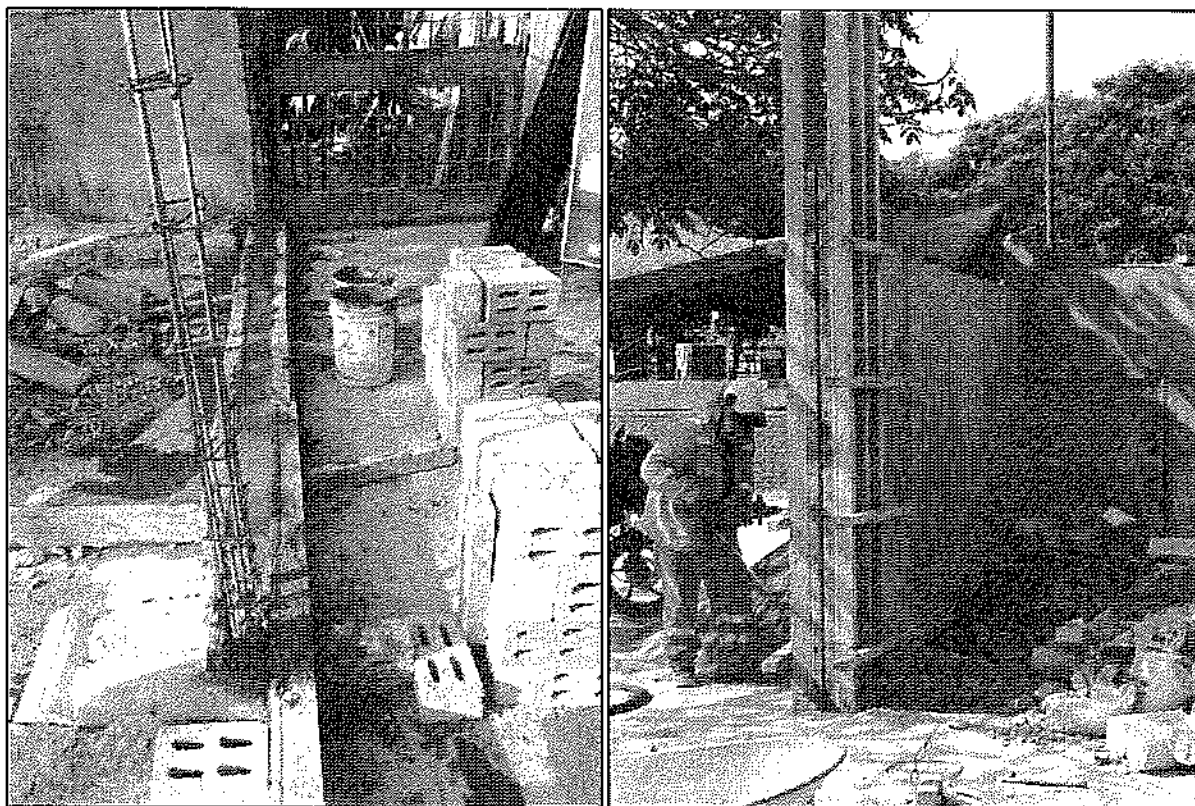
Vaciado de sobre cemento - Botadero LEM. Armado y encofrado de Columna
